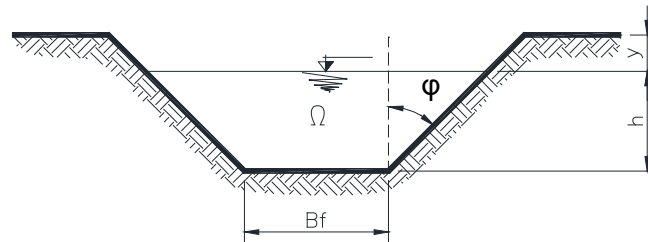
Canal trapezoidal (fuente: elaboración propia)
